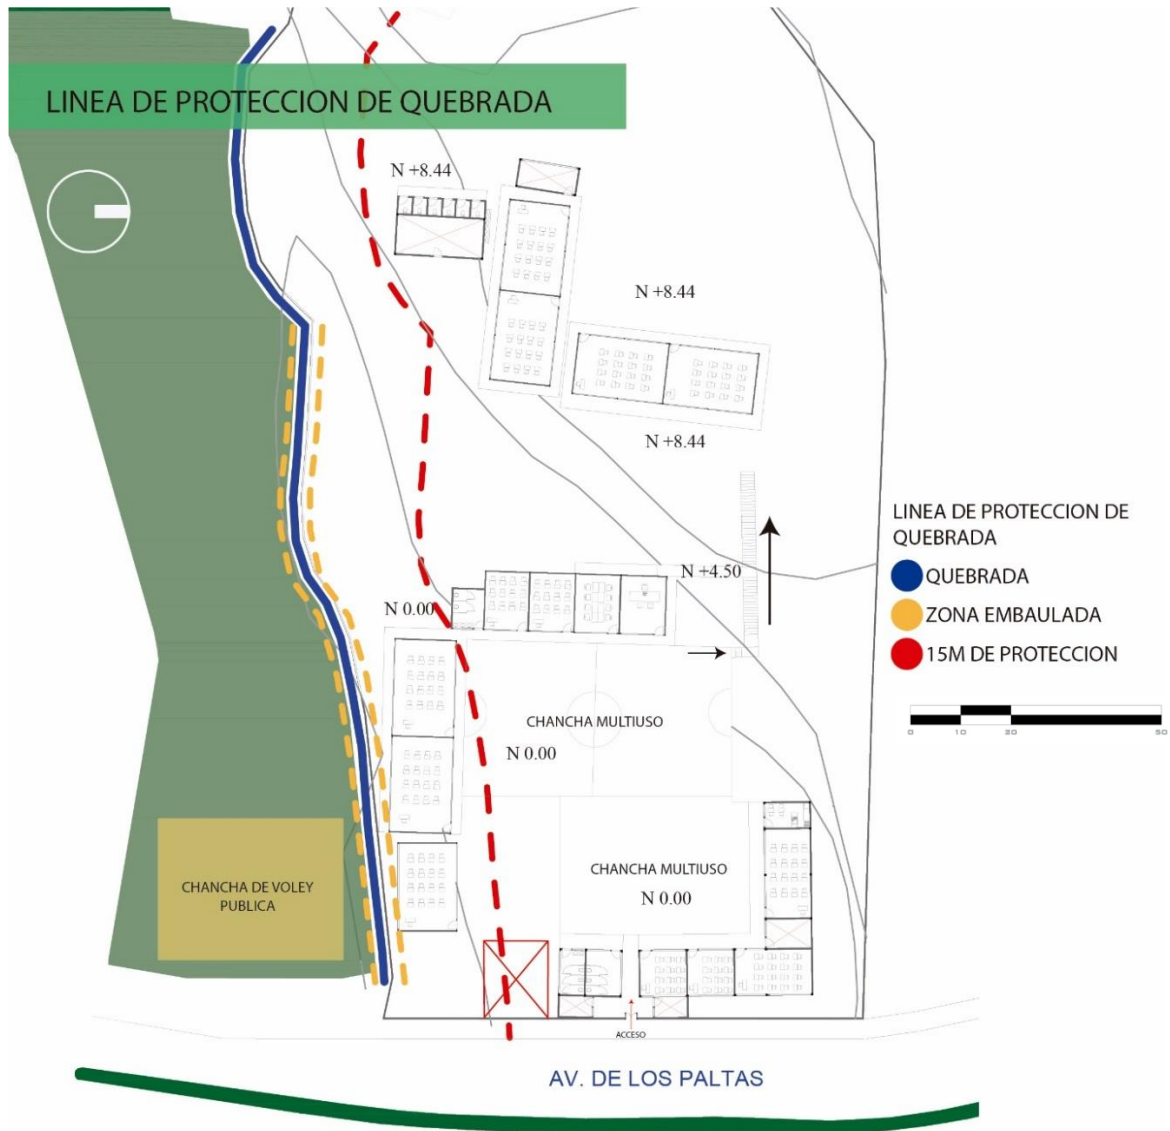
Plano de edificación preexistente y zonificación. Estado actual de la escuela
